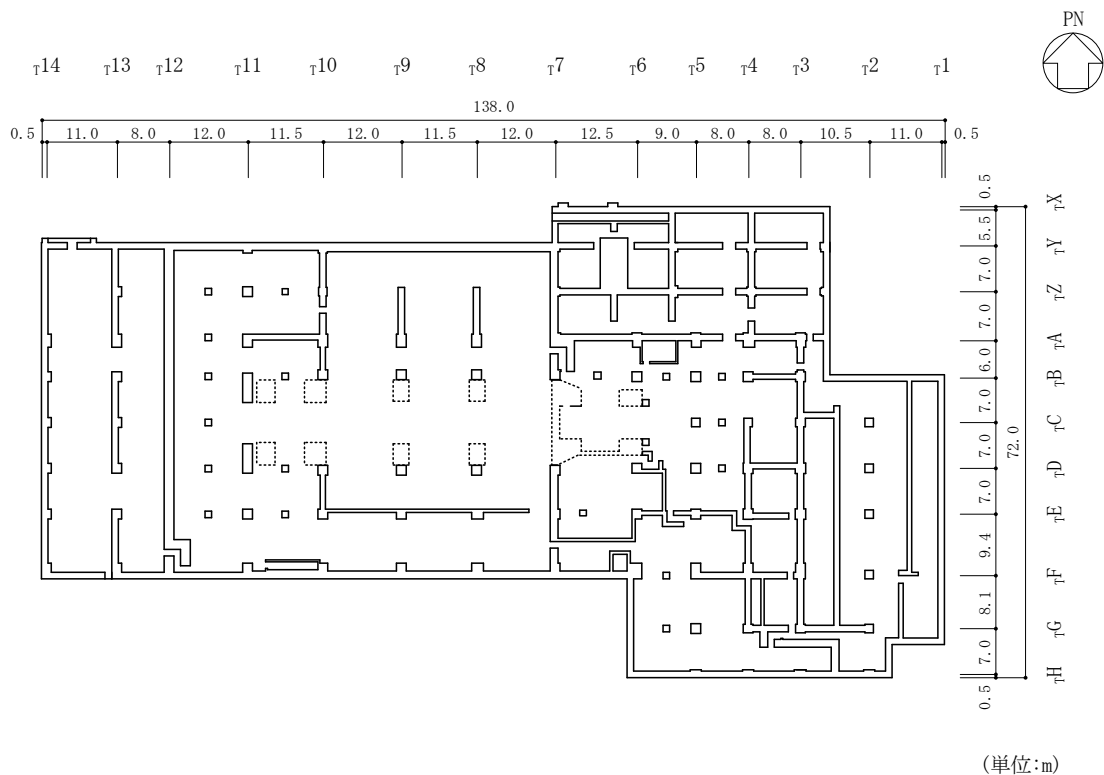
(1) タービン建物の概略平面図 (EL 2.0m*)
